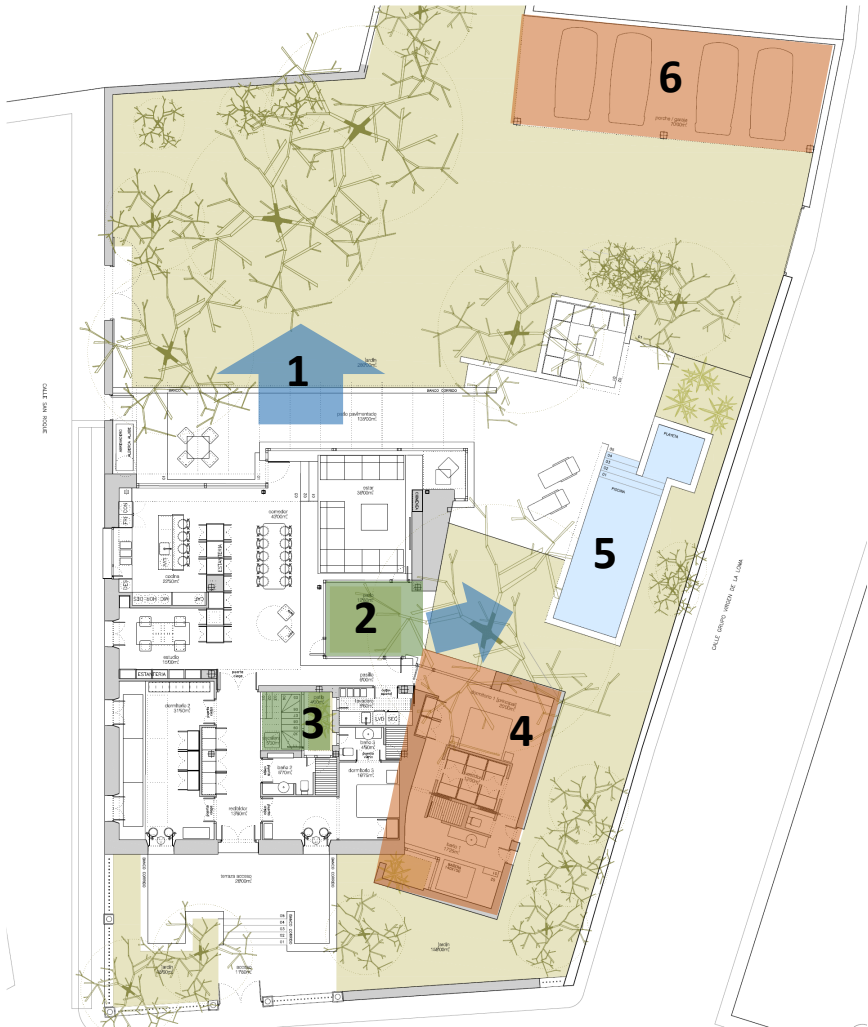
Plano de la vivienda reformada. 2023. Fuente: propia.
